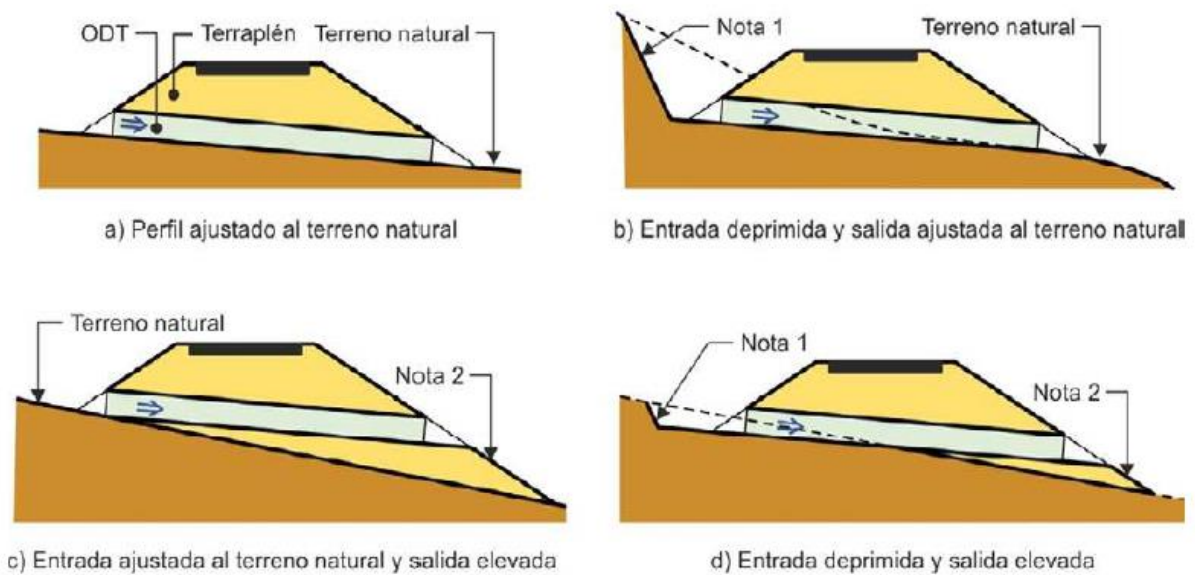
Tipos de encaje de perfil longitudinal en ODTs.
